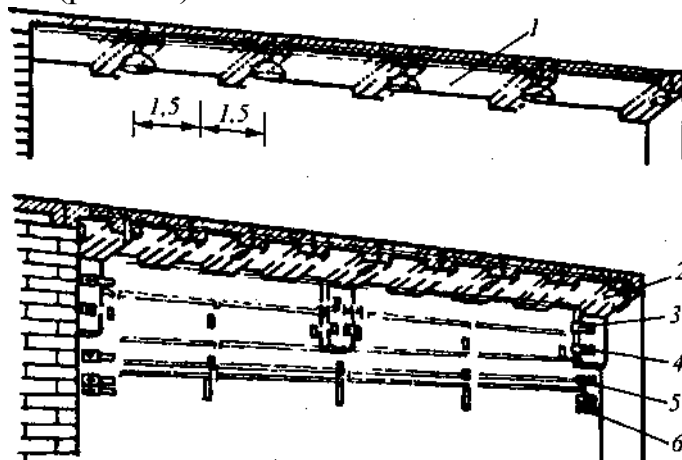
Струнна електропроводка: 7 — підвішування проводки до струни, що закріплена на перекритті; 2—6 — кріплення струни (до коробки перекриття, виступів стіни, виступів стін і впритул; до стін впритул; здвоєної до рівної основи)
